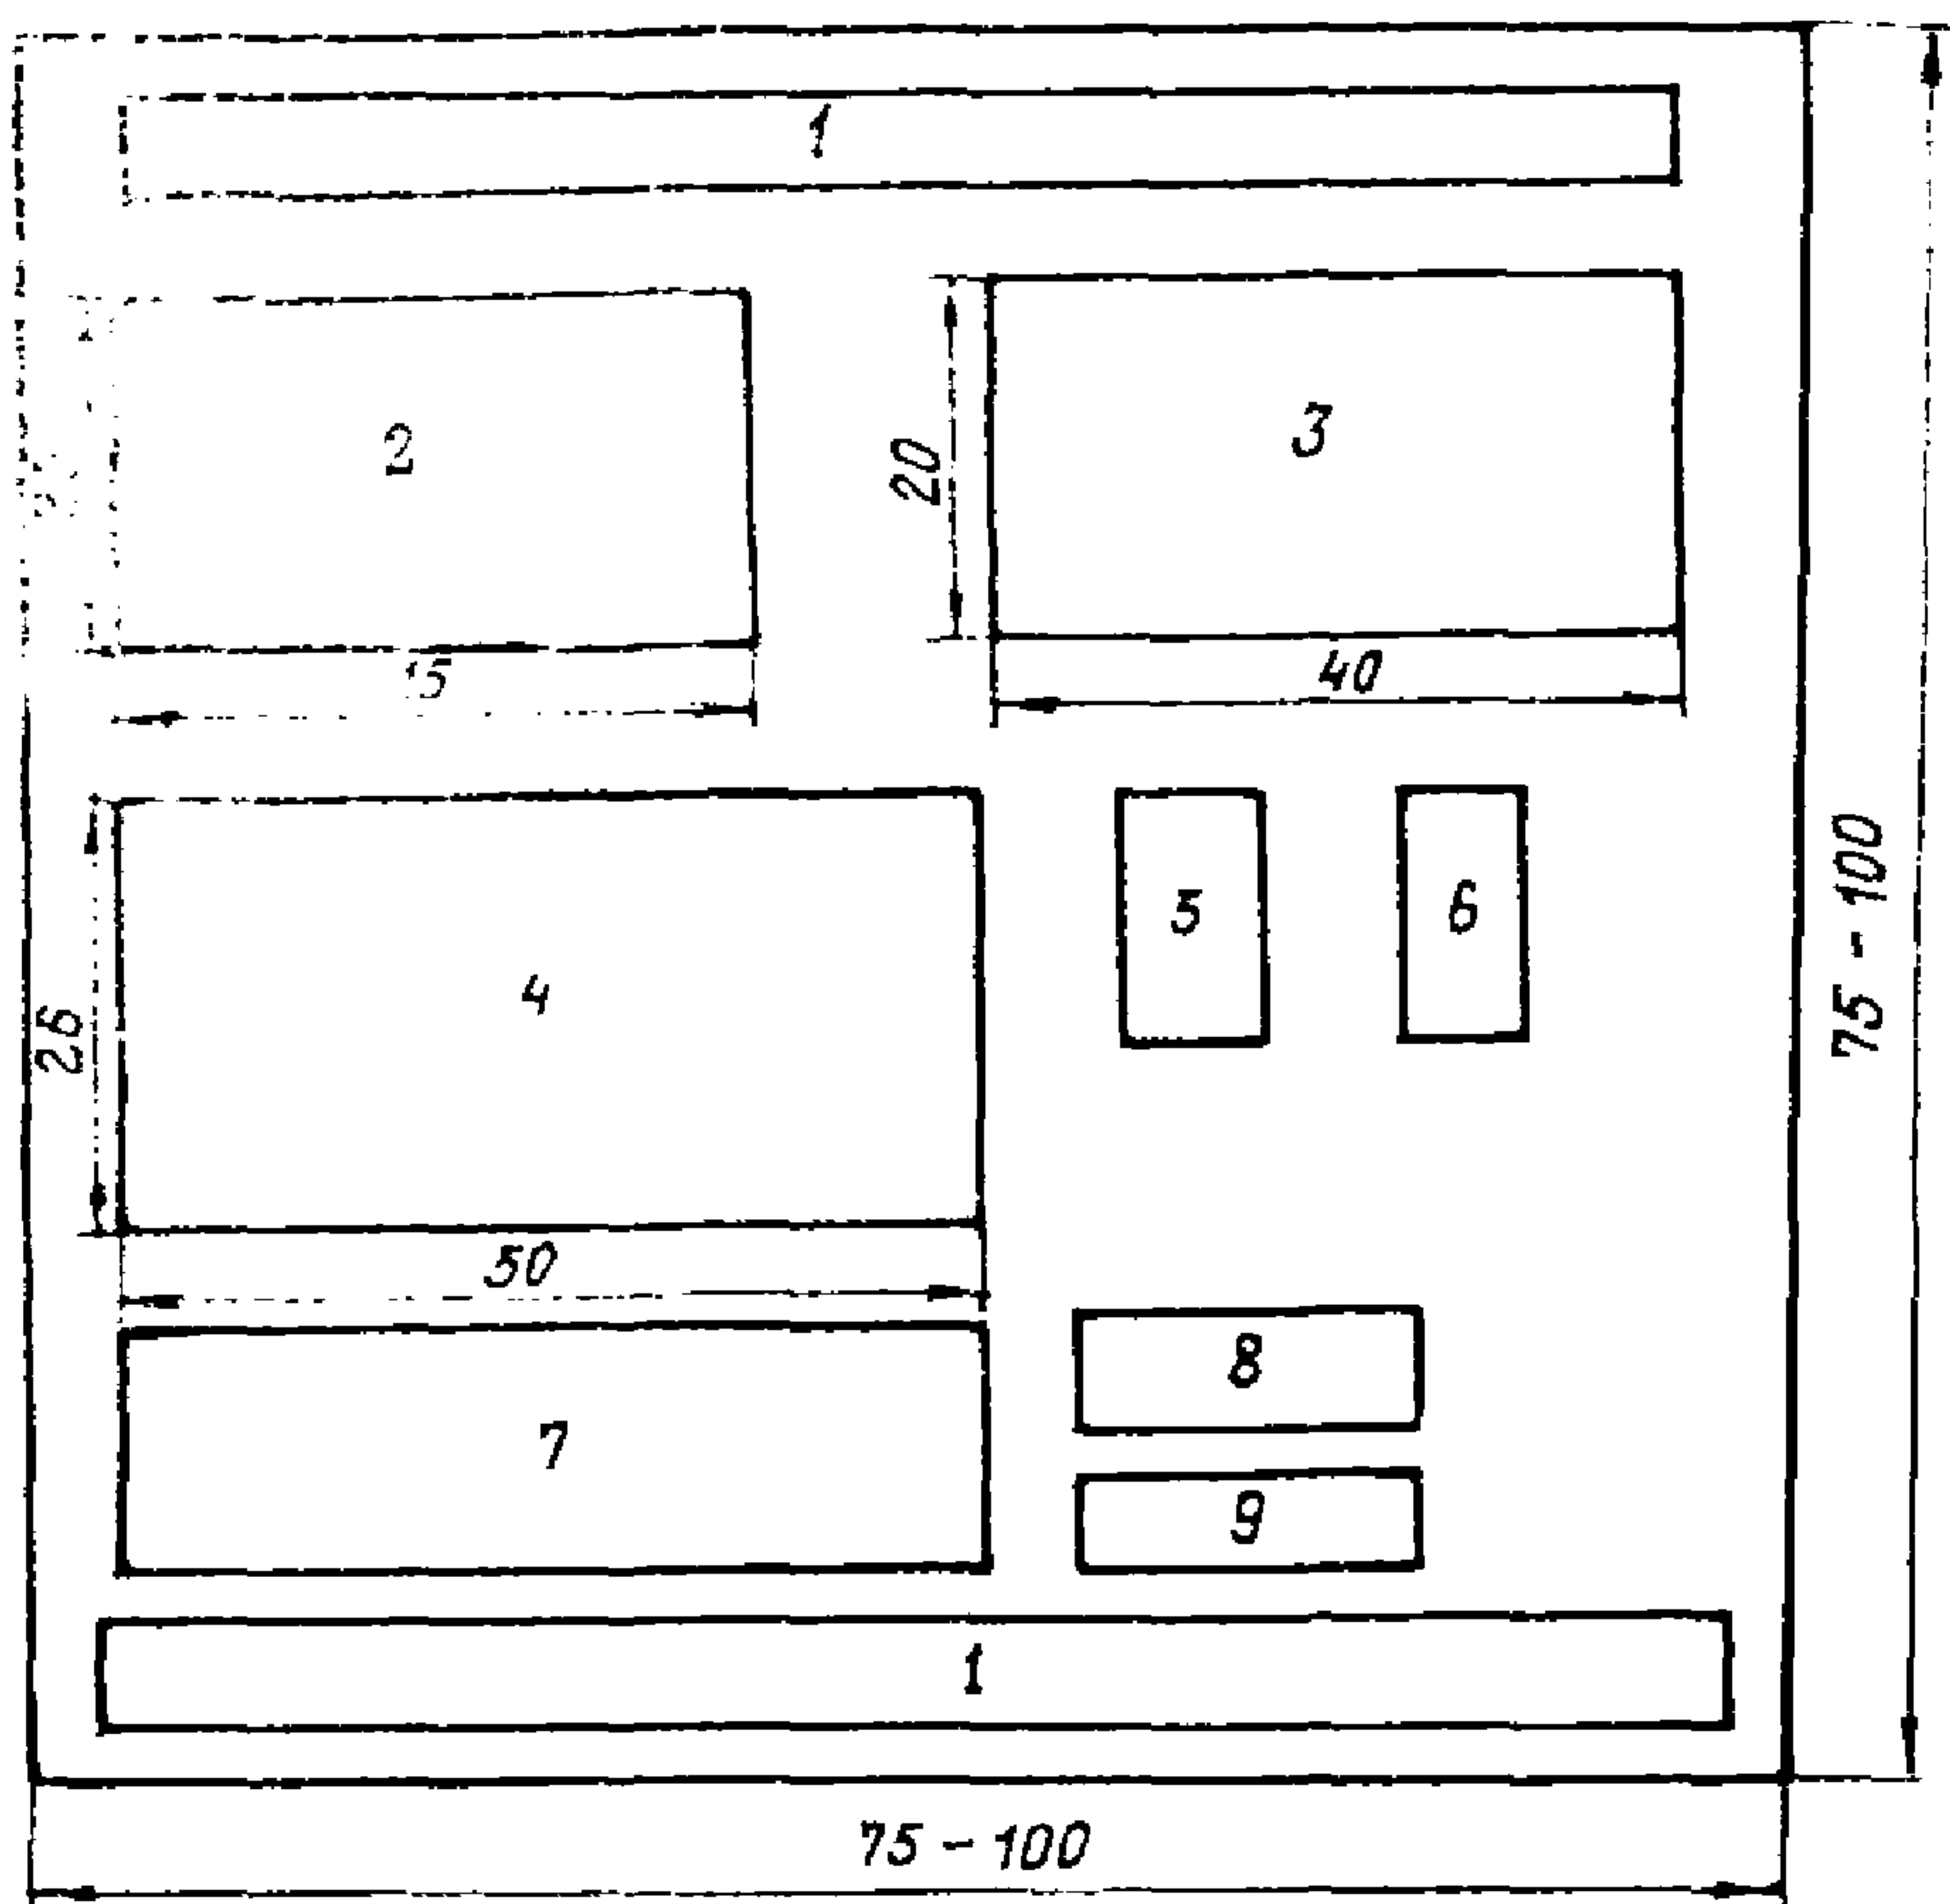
Типовой генплан сварочной базы с использо-
